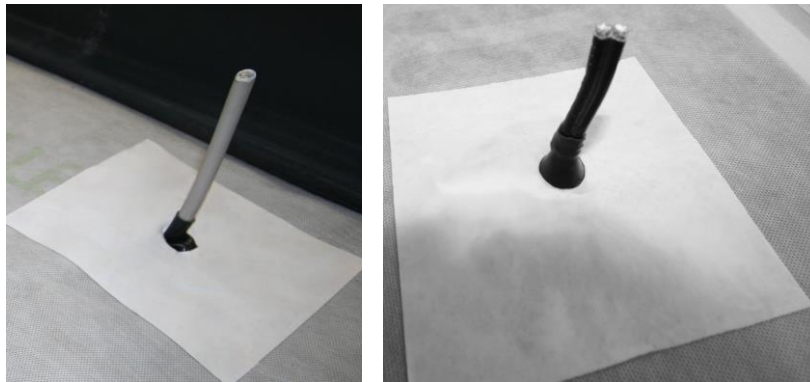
Hausanschlusskabel abgedichtet mit KABSEAL PRO 22-25 (links) und Anschluss an ein Kabelleerrohr (Wellrohr) mit KABSEAL PRO 22-25 (rechts).
